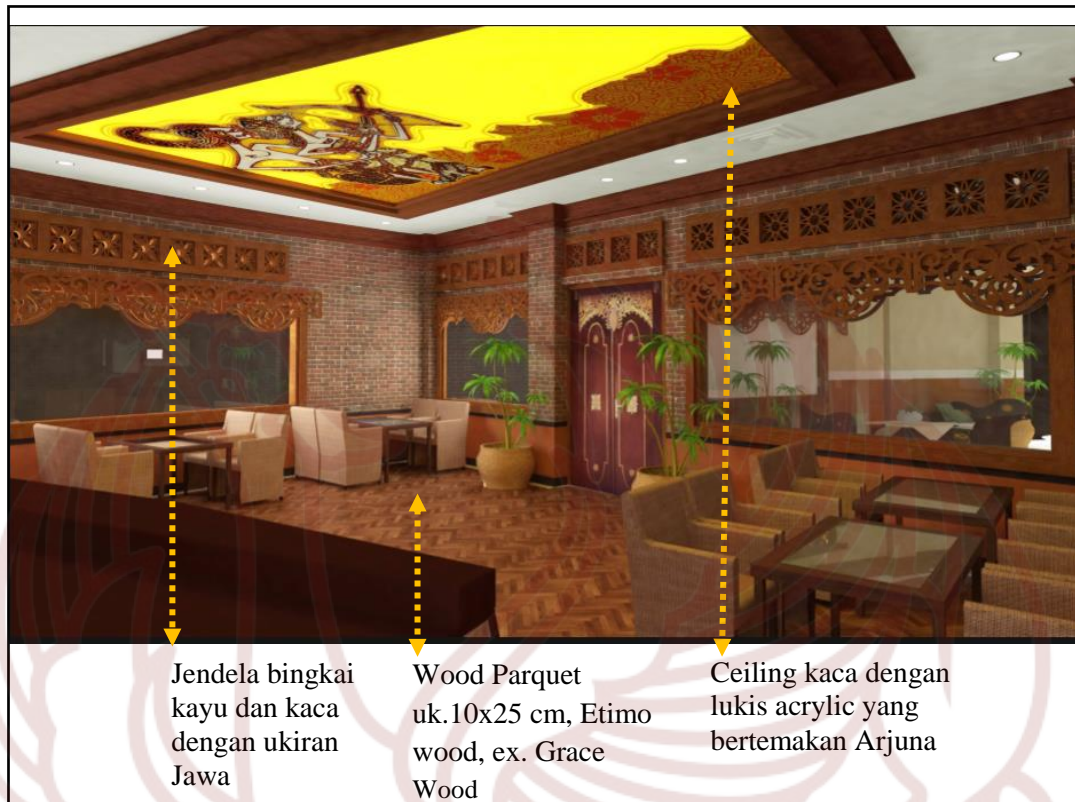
Hasil dan penerapan desain lantai ruang cafeteria
